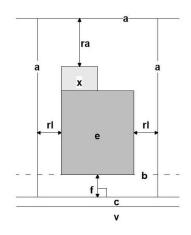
; MIX-r-Bande de construction La bande de construction n'est pas limitée.
